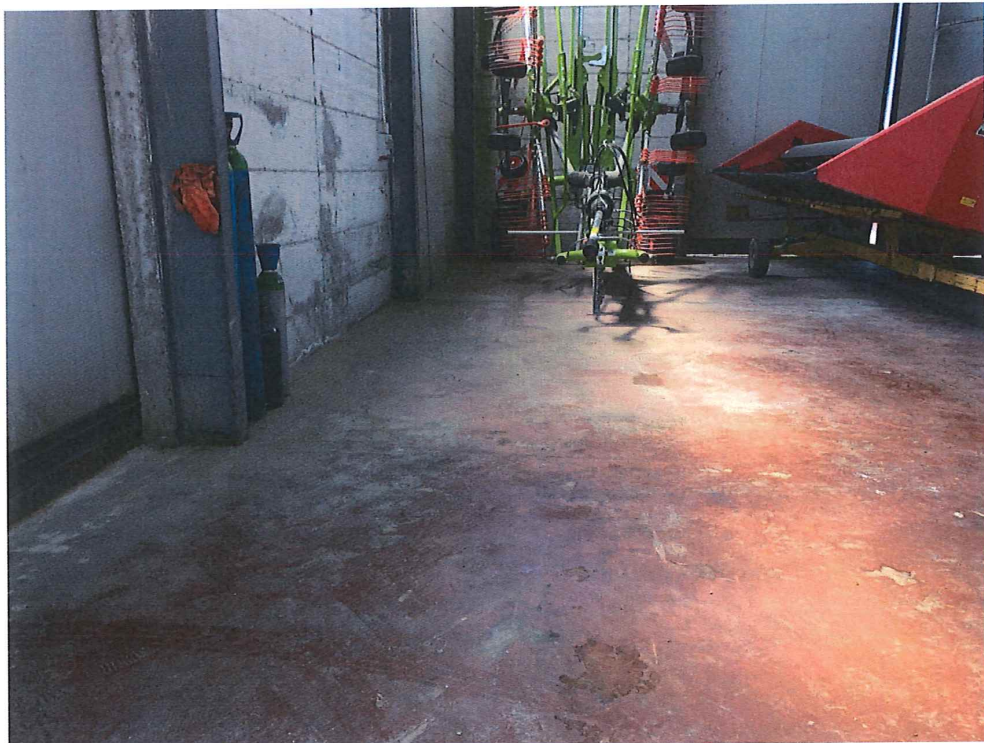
Bettona. Interno capannone: particolare pavimentazione.
